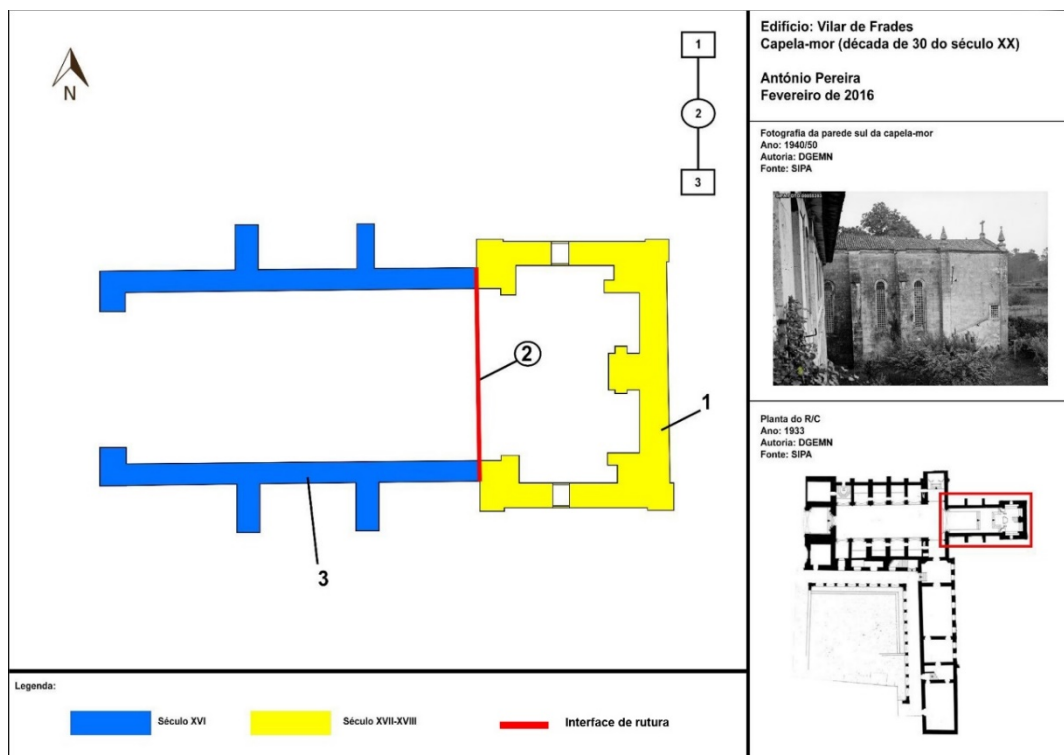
Leitura da planta da capela-mor de 1933 ainda com o prolongamento construído em 1697.
